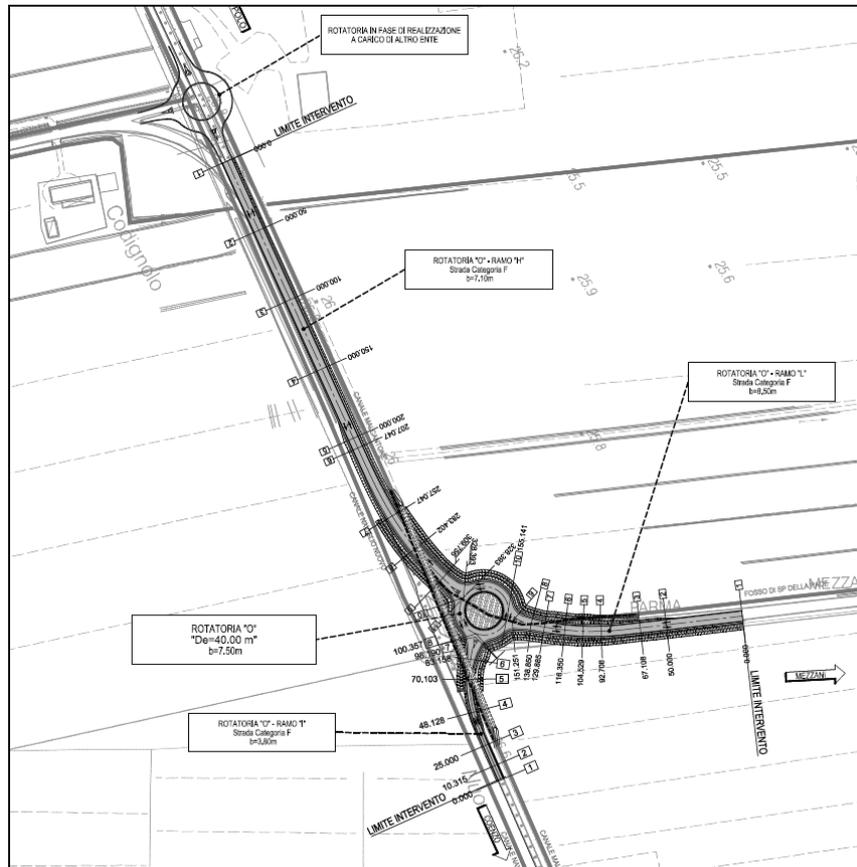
PLANIMETRIA DI PROGETTO – TRATTO 3
